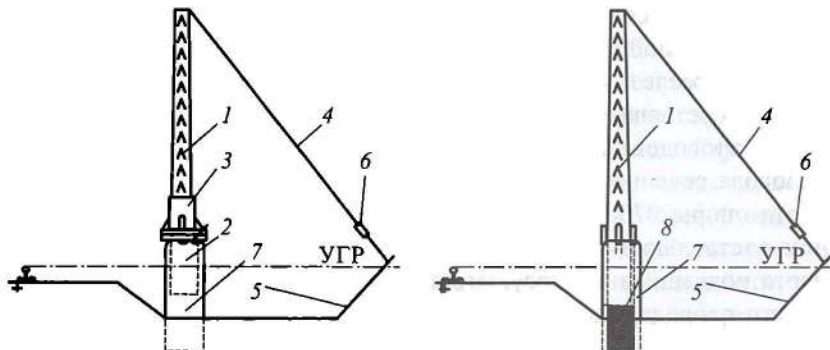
Деревянная опора с нормативным изгибающим моментом 4,5 тс·м с закладным фундаментом (а) и без него (б):
